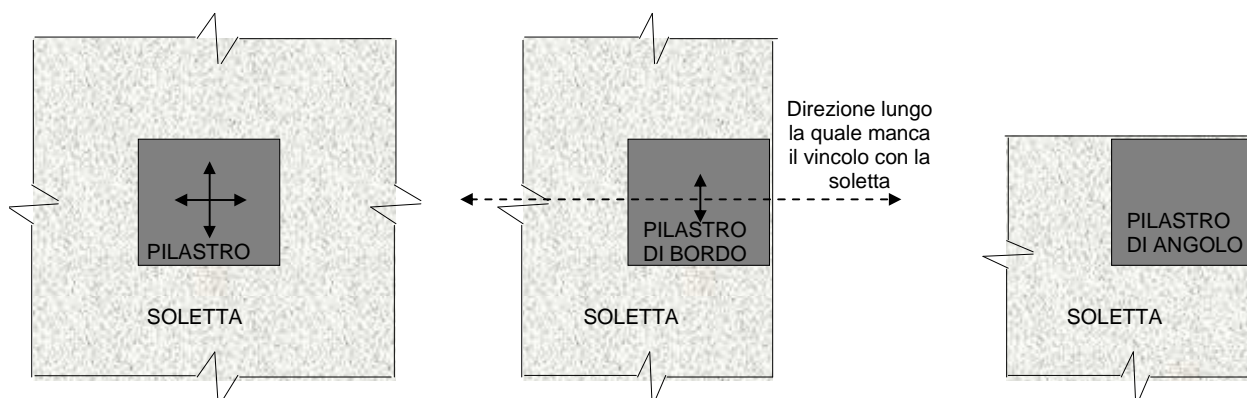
Condizione del pilastro interno rispetto ai pilastri di bordo e d'angolo
